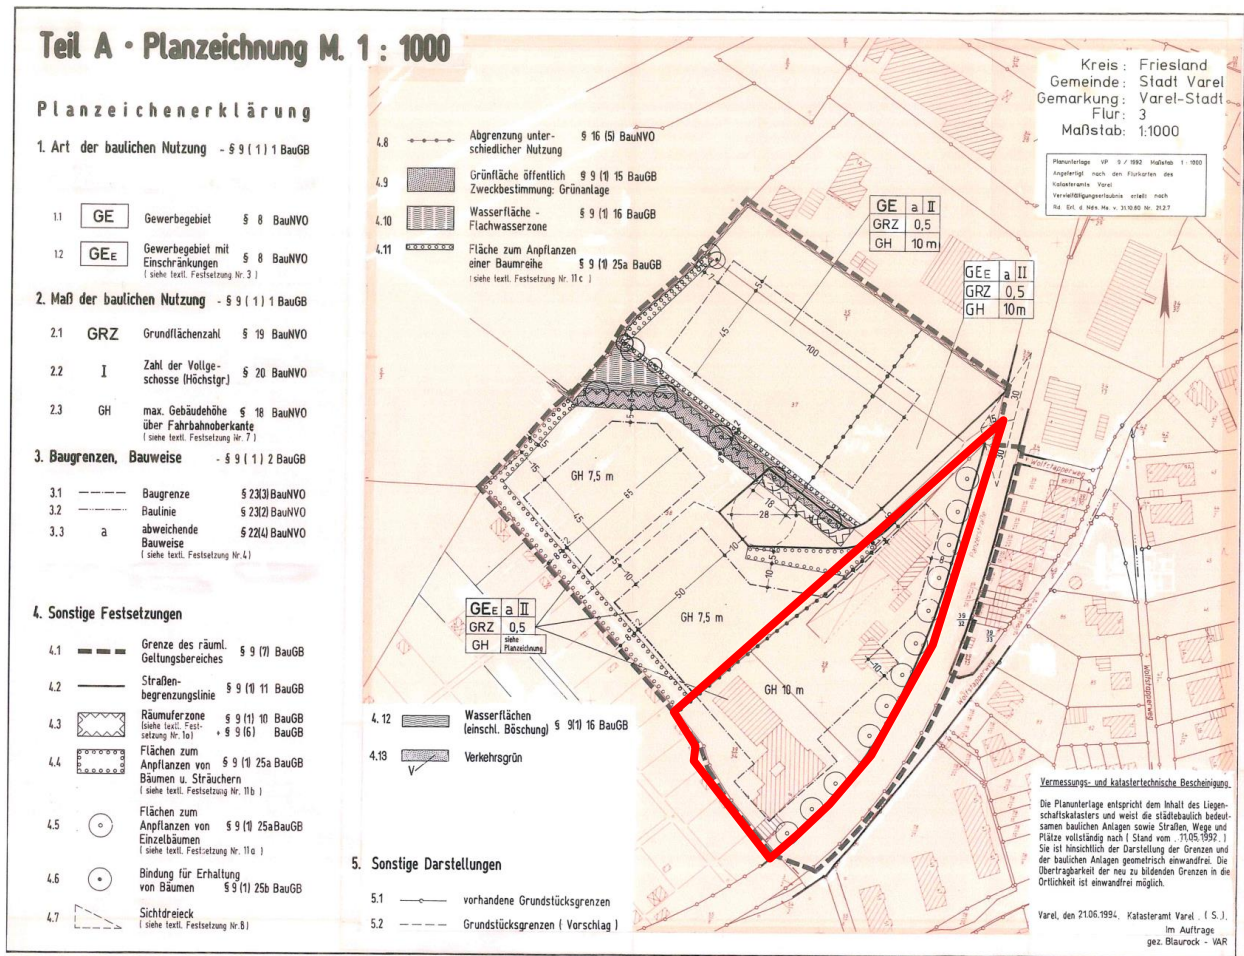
Planzeichnung Bebauungsplan 122 „Gewerbegebiet Panzerstraße“, 16.09.1994 mit Kennzeichnung Planbereich der 1. Änderung
